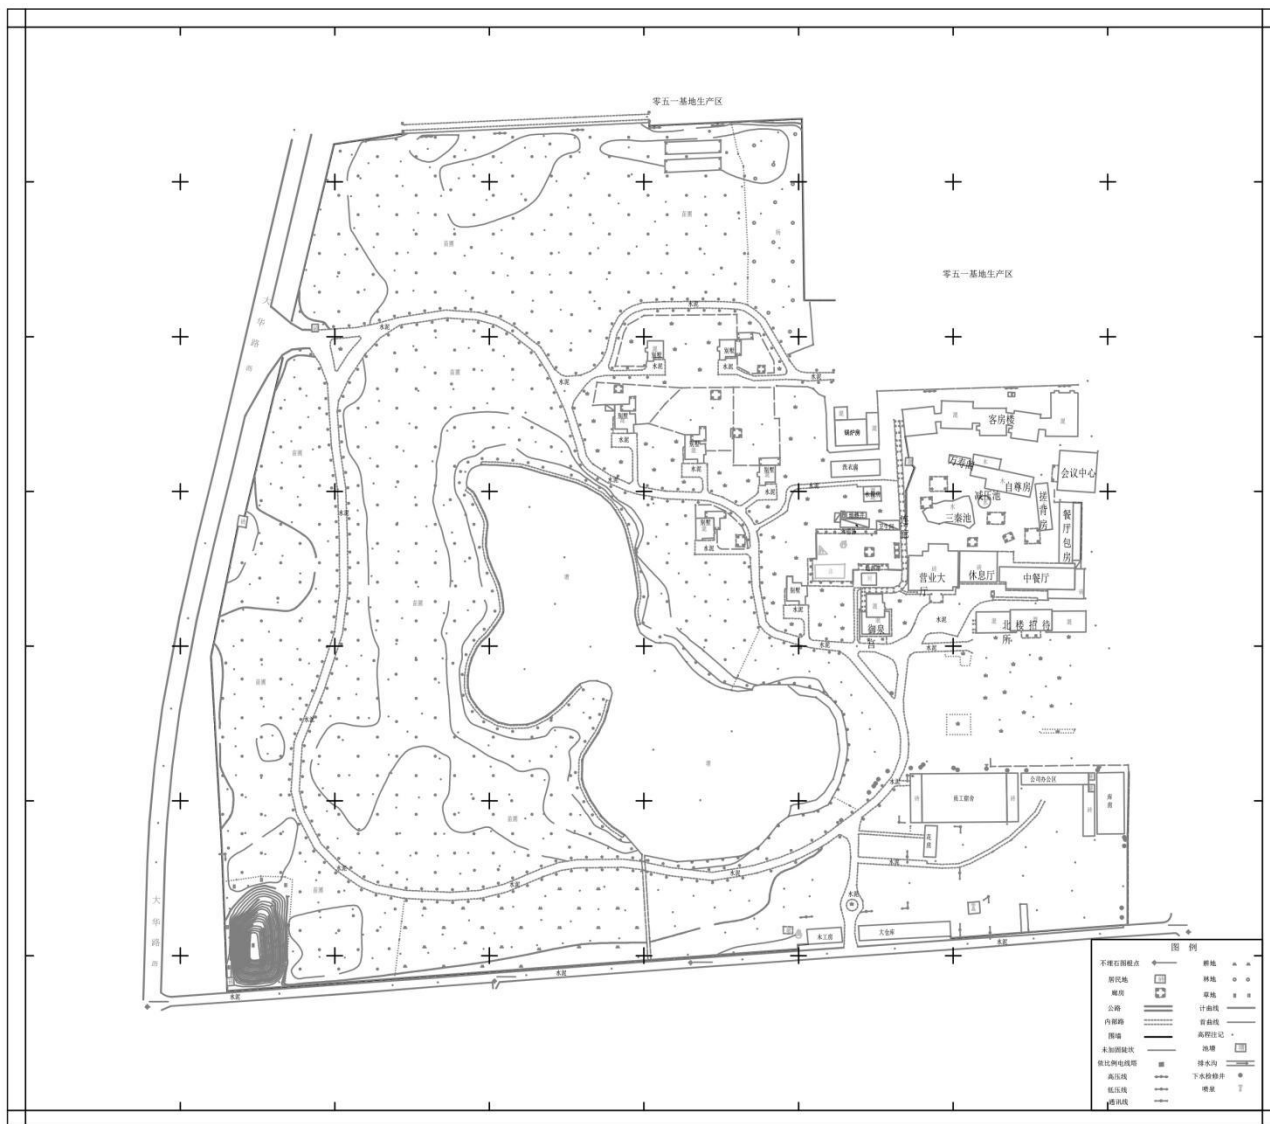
华阴零五一试验服务有限公司平面布置示意图
